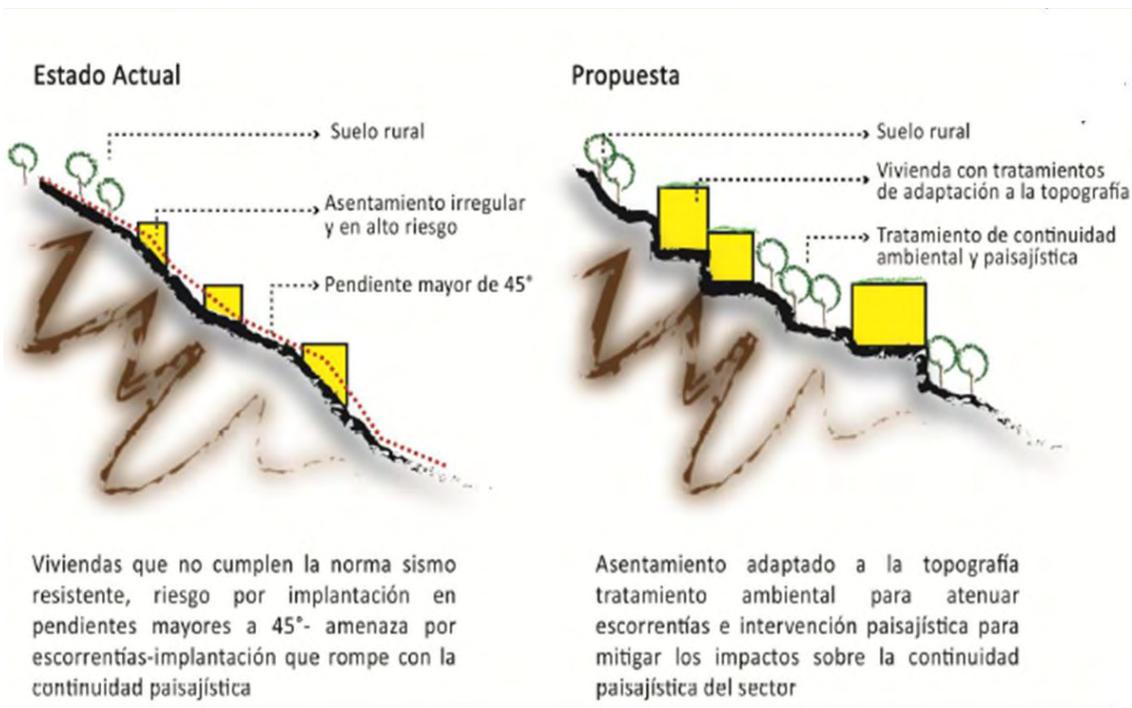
Concepto Vivienda Paisaje. Fuente: Elaboración Propia.
